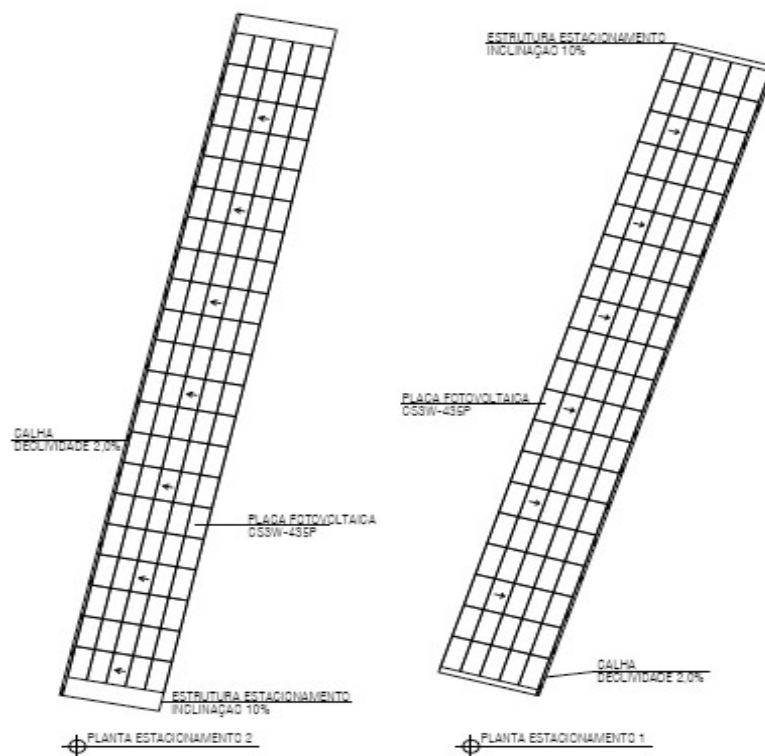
Planta baixa dos estacionamentos 1 e 2 (sem escala)
